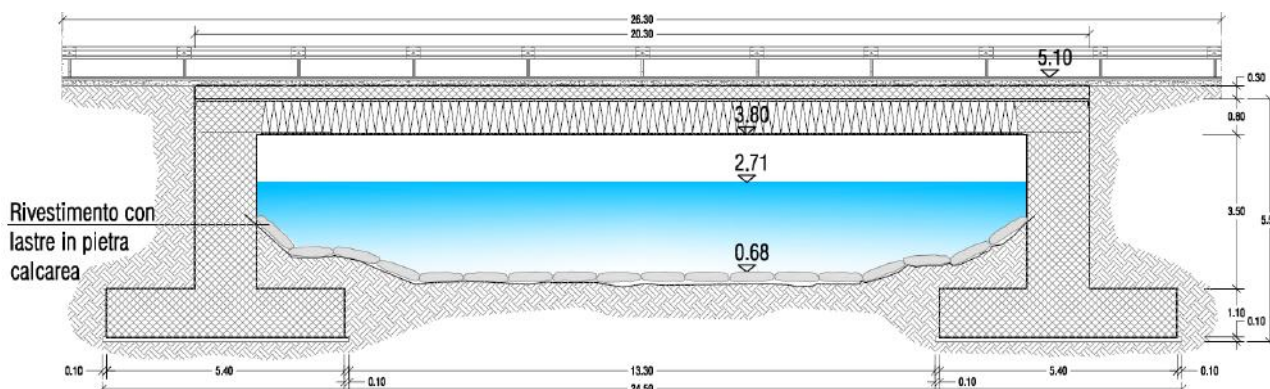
Particolare attraversamento Ex S.S: 16 e strada Padula
